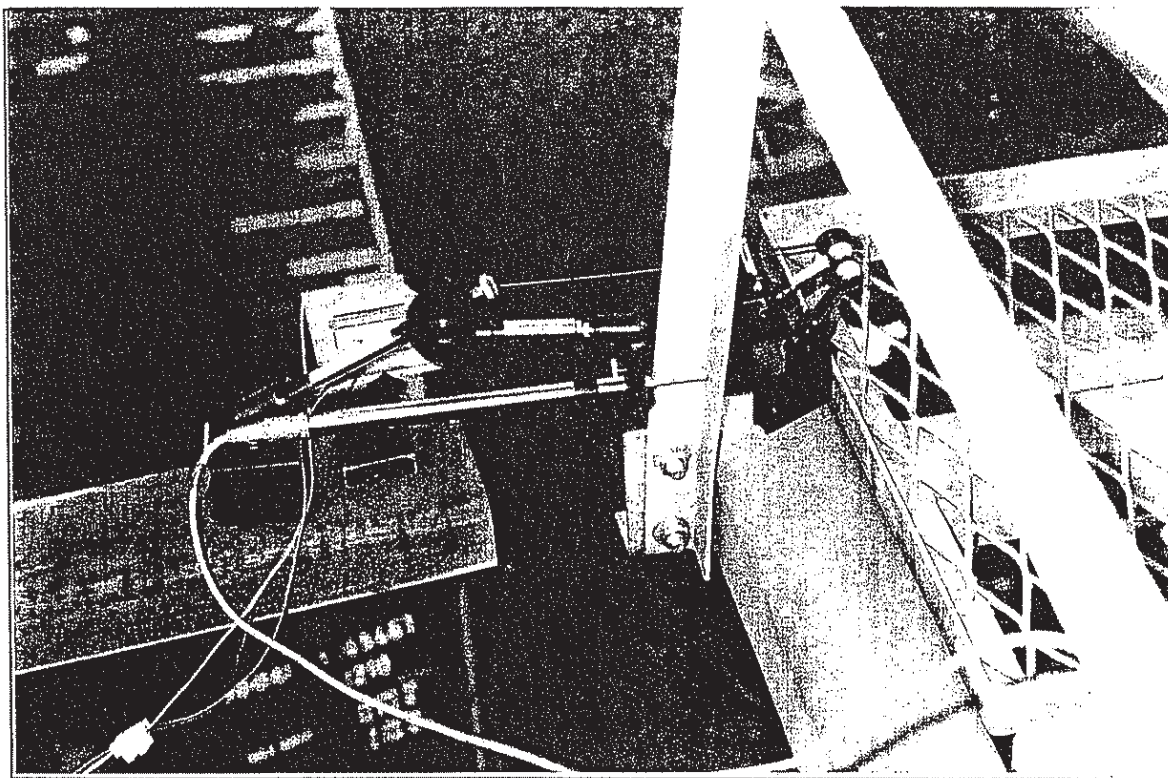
Applicazione degli estensimetri sulle fiancate della traversa
